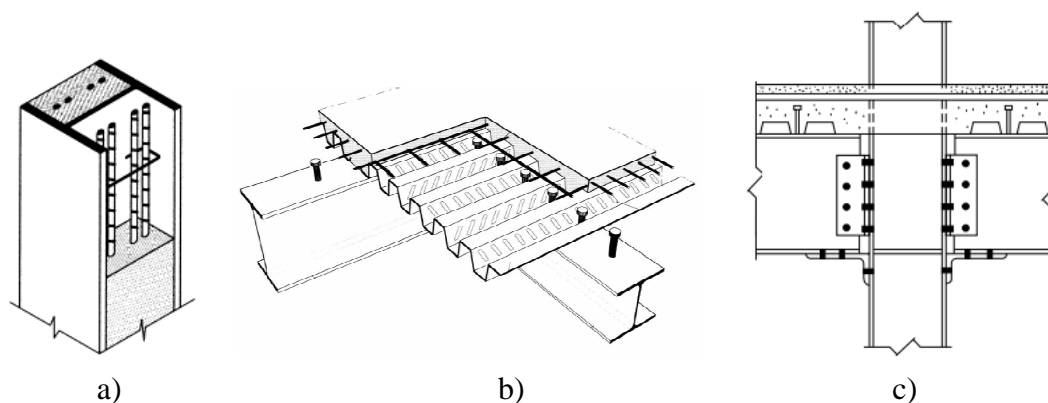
Exemplos de elementos estruturais mistos: a) Pilar misto, b) Viga e laje mistas, c) Ligação mista
